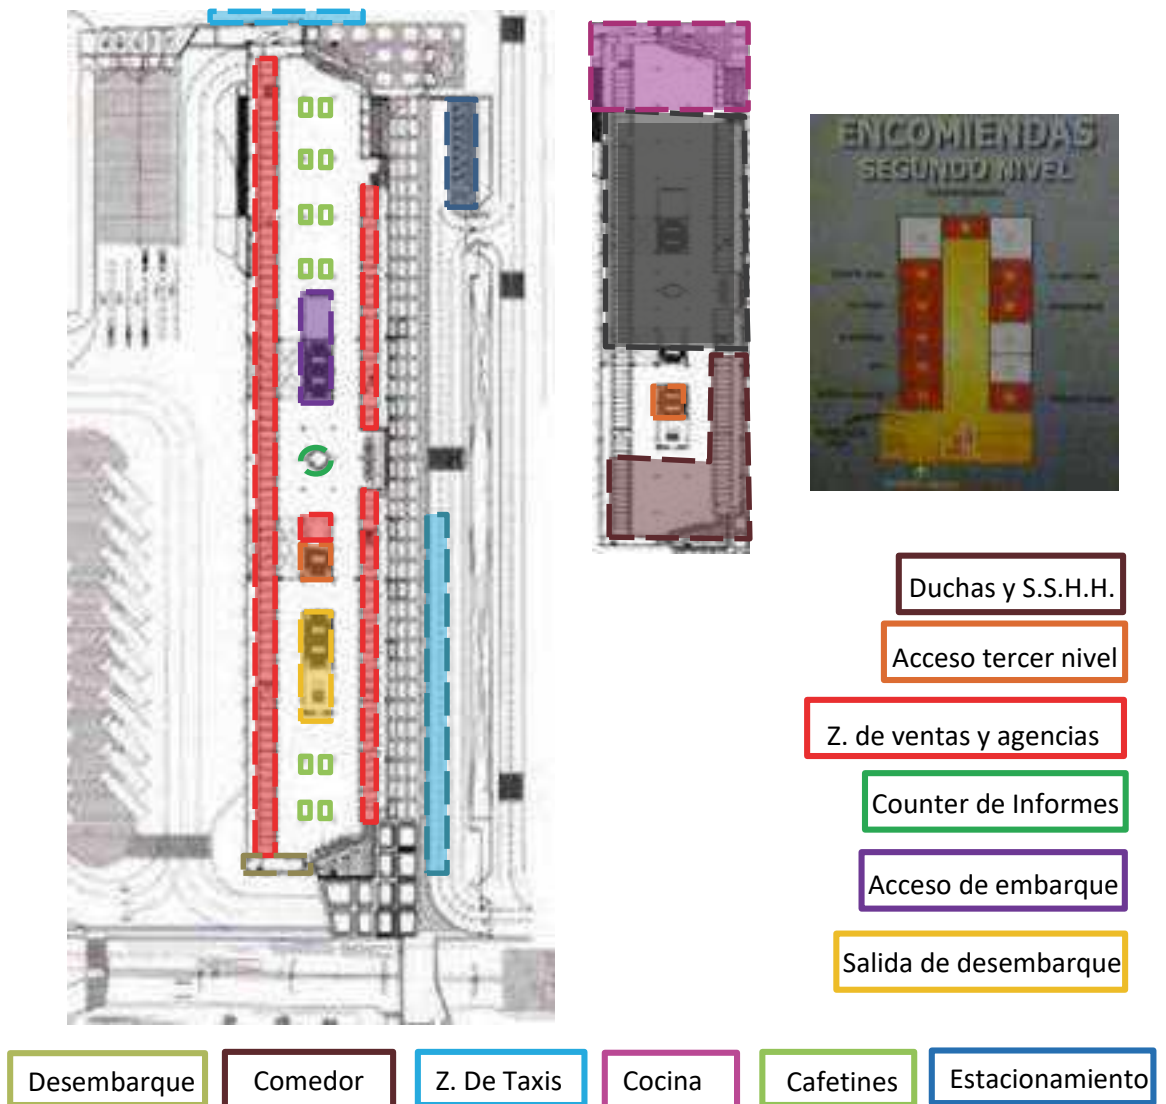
Segunda Planta – Tercera Planta – Zona de Encomiendas
